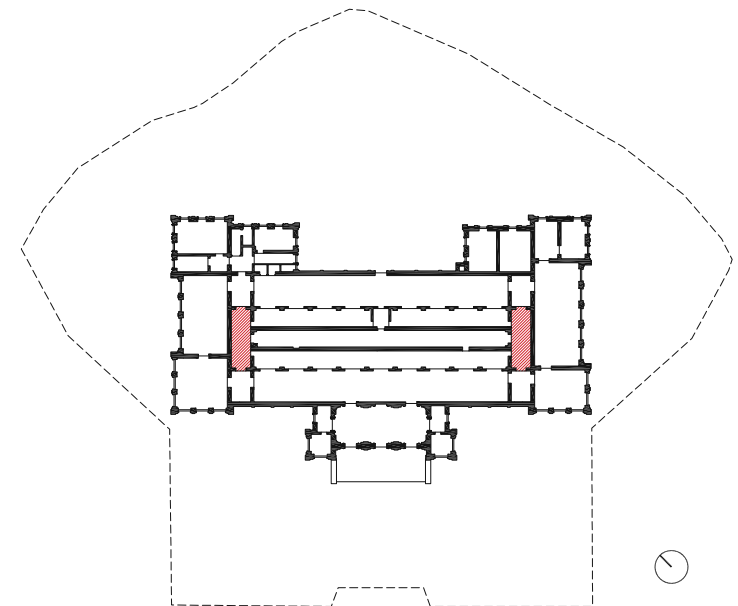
Planausschnitte Vorrichteräume | Lageplan der BVA um 1905
